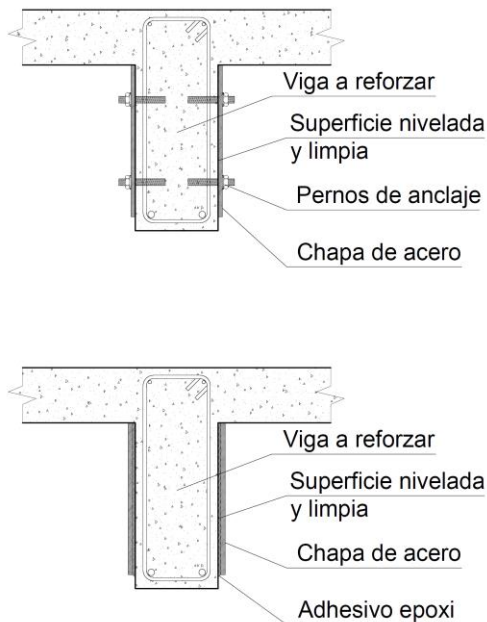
Refuerzo de viga mediante chapas o perfiles de acero Alternativas mediante anclajes y adhesivo
